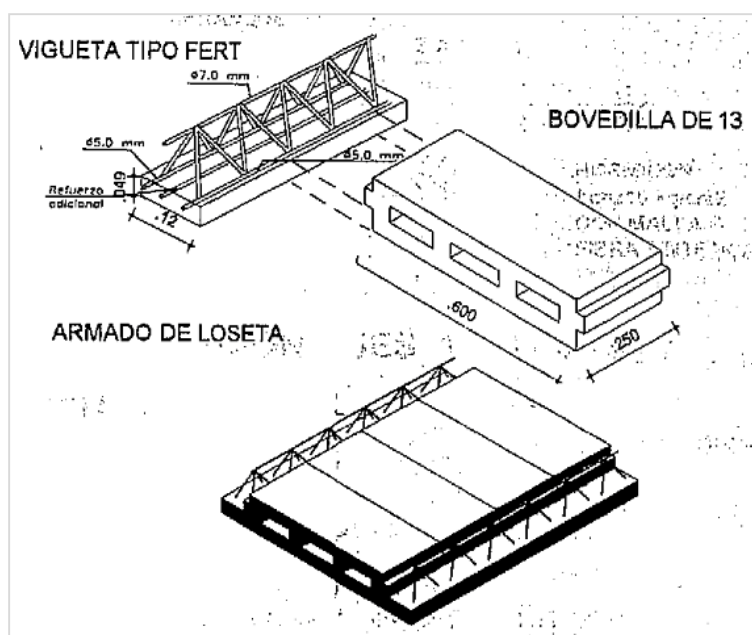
Elementos de losa aligerada. Casa C58SG
